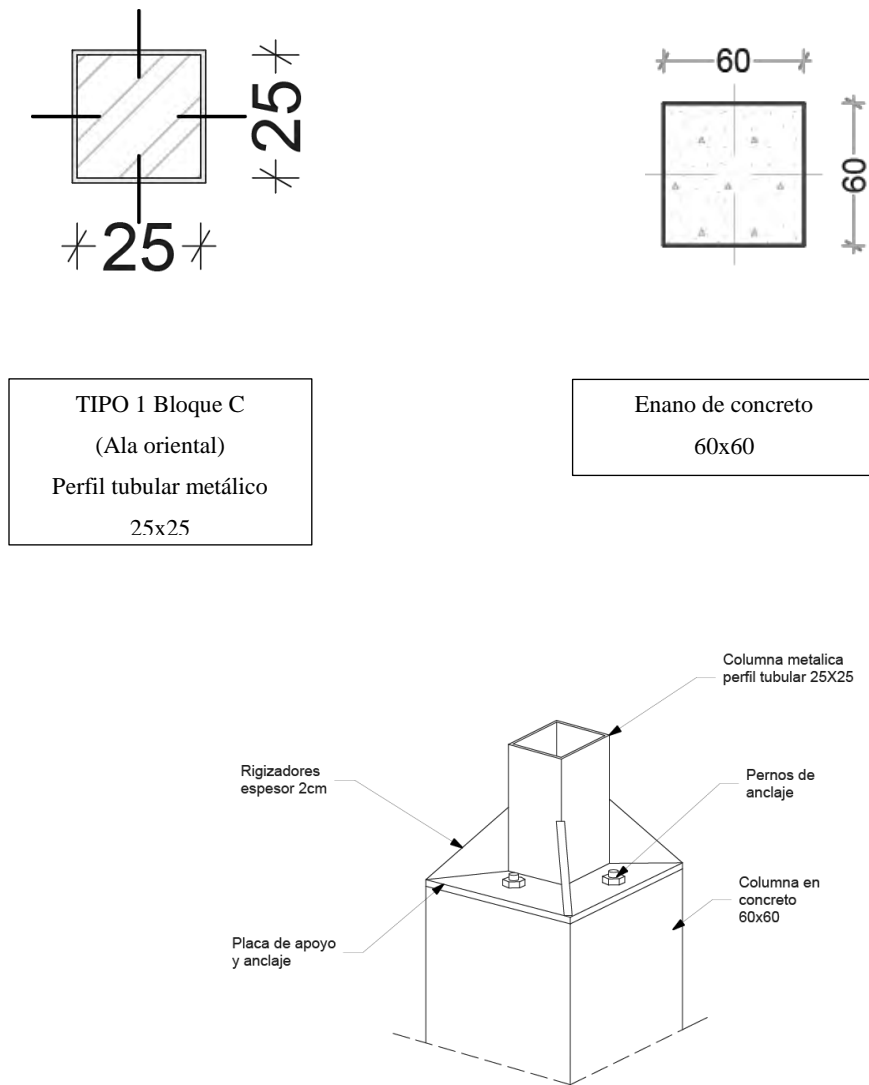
Detalle conexión de enano de concreto con columna en perfil metálico tubular. Fuente: Elaboración Propia.
